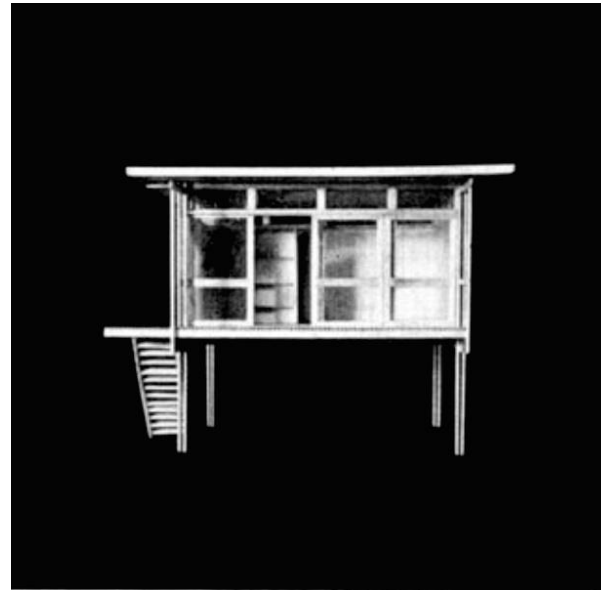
Fachada do pavilhão de 25m<sup>2</sup> executado em maquete. Fonte: Pedrosa (1960, p. 5).
